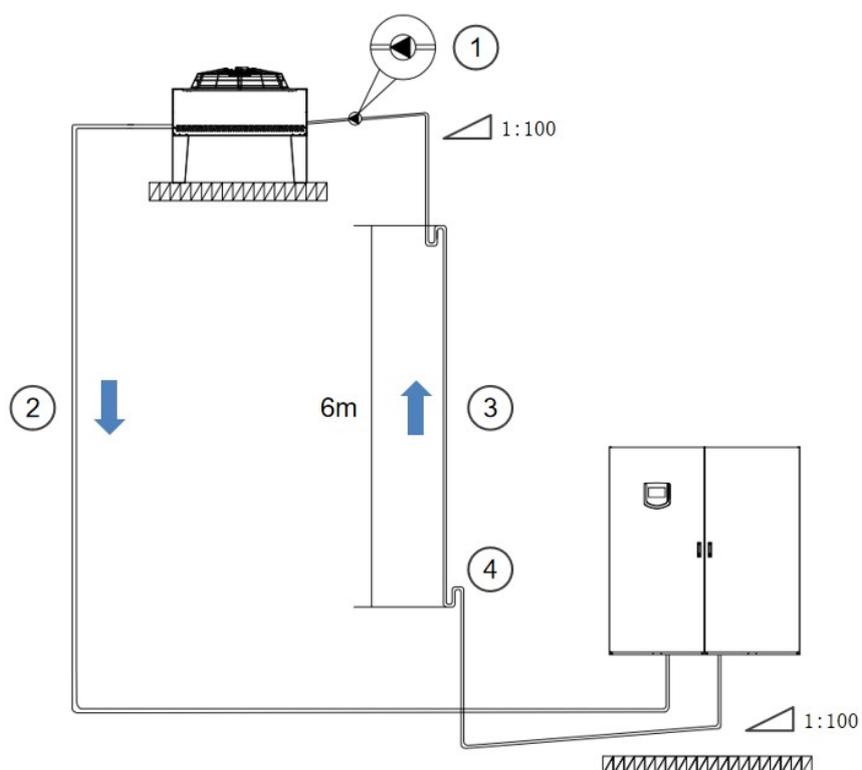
Схема установки стандартного конденсатора выше внутреннего блока
